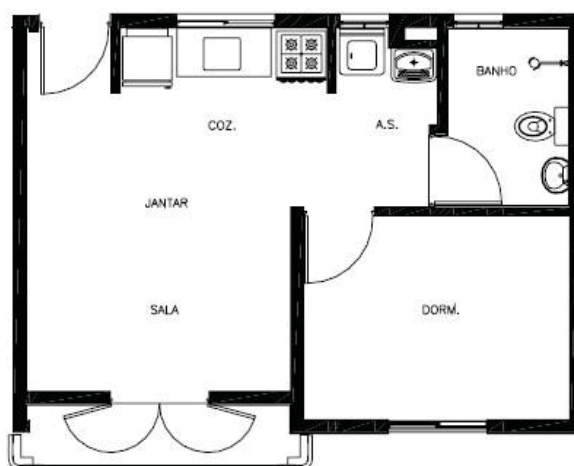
Planta baixa – Ap. de 1 dormitório – Conj. Parque do Gato
